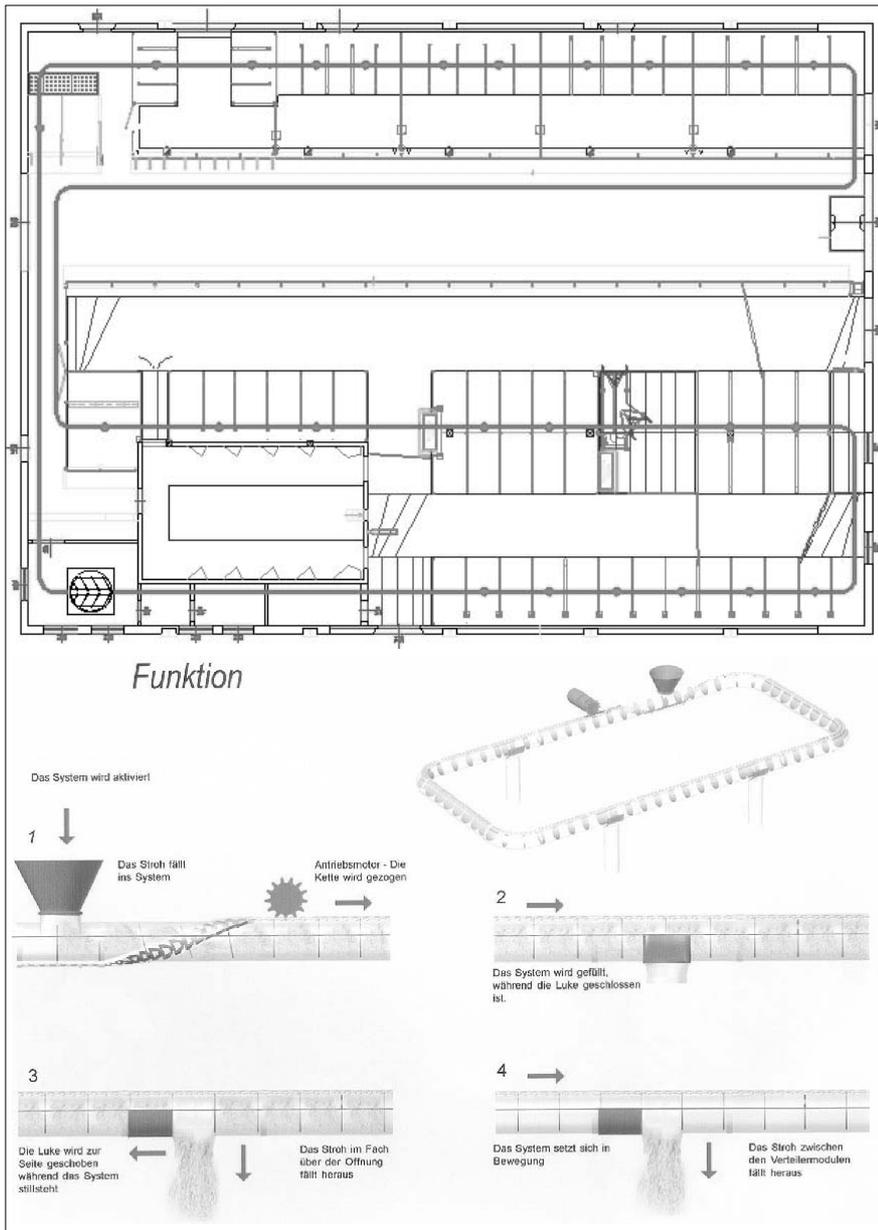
Grundriss und Funktion eines festeingebauten Einstreusystems für mehrere Einstreuachsen zur dosierten und staubfreien Strohverteilung
